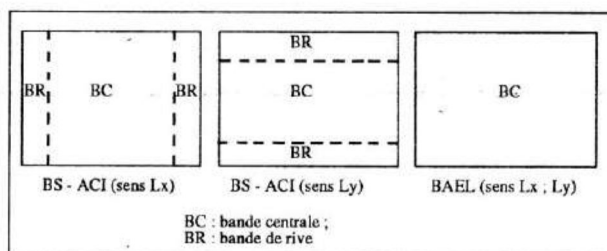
Division réglementaire d'un panneau de dalle en bandes.
